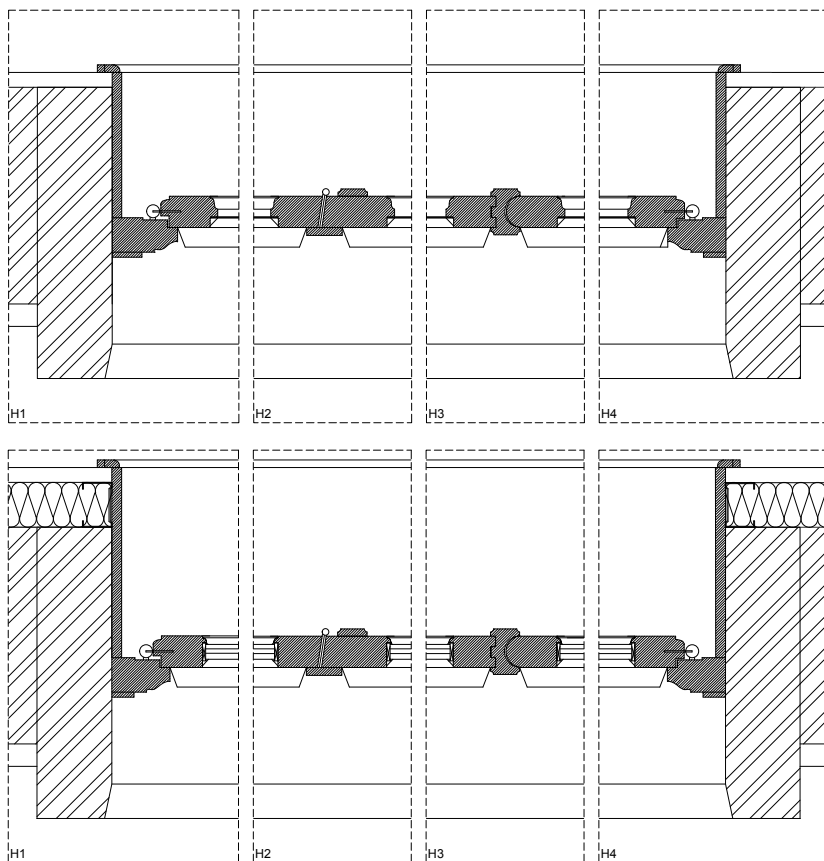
VE1 | Levantamento e proposta | Planta | Escala 1.10
